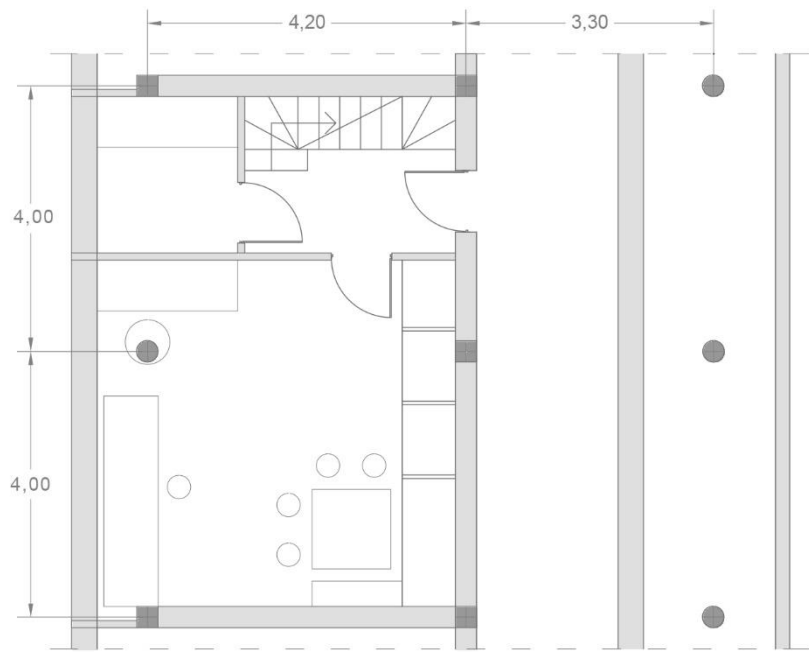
Planta baja de tipología K. Fuente: Elaboración propia
